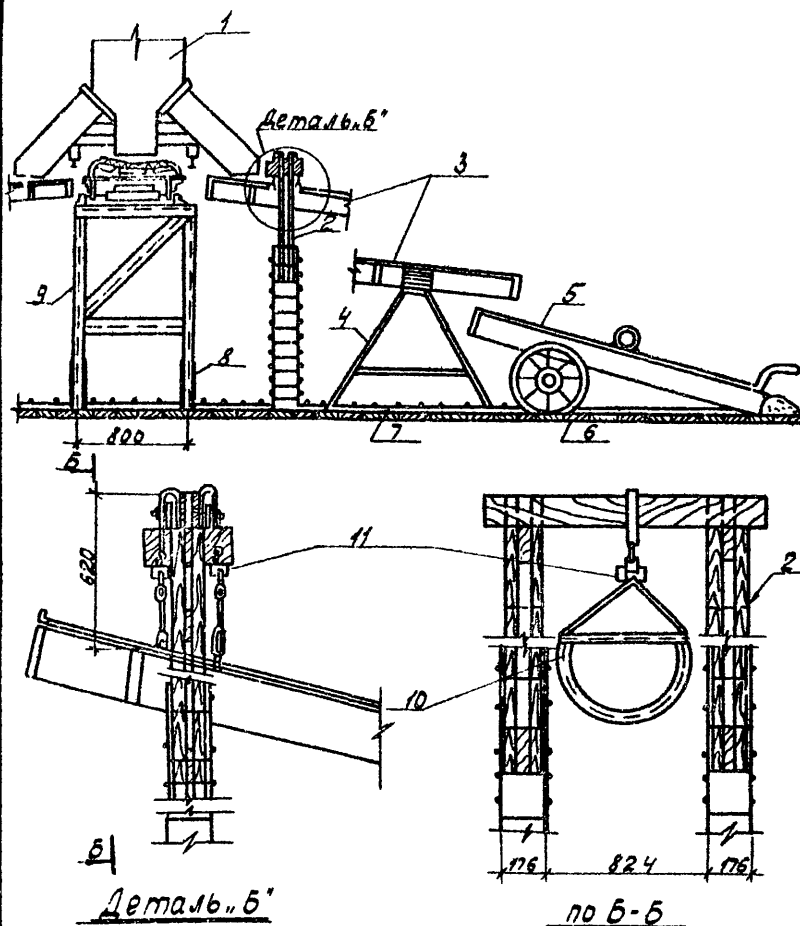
Схема подачи механизированной укладки бетона в перекрытие
